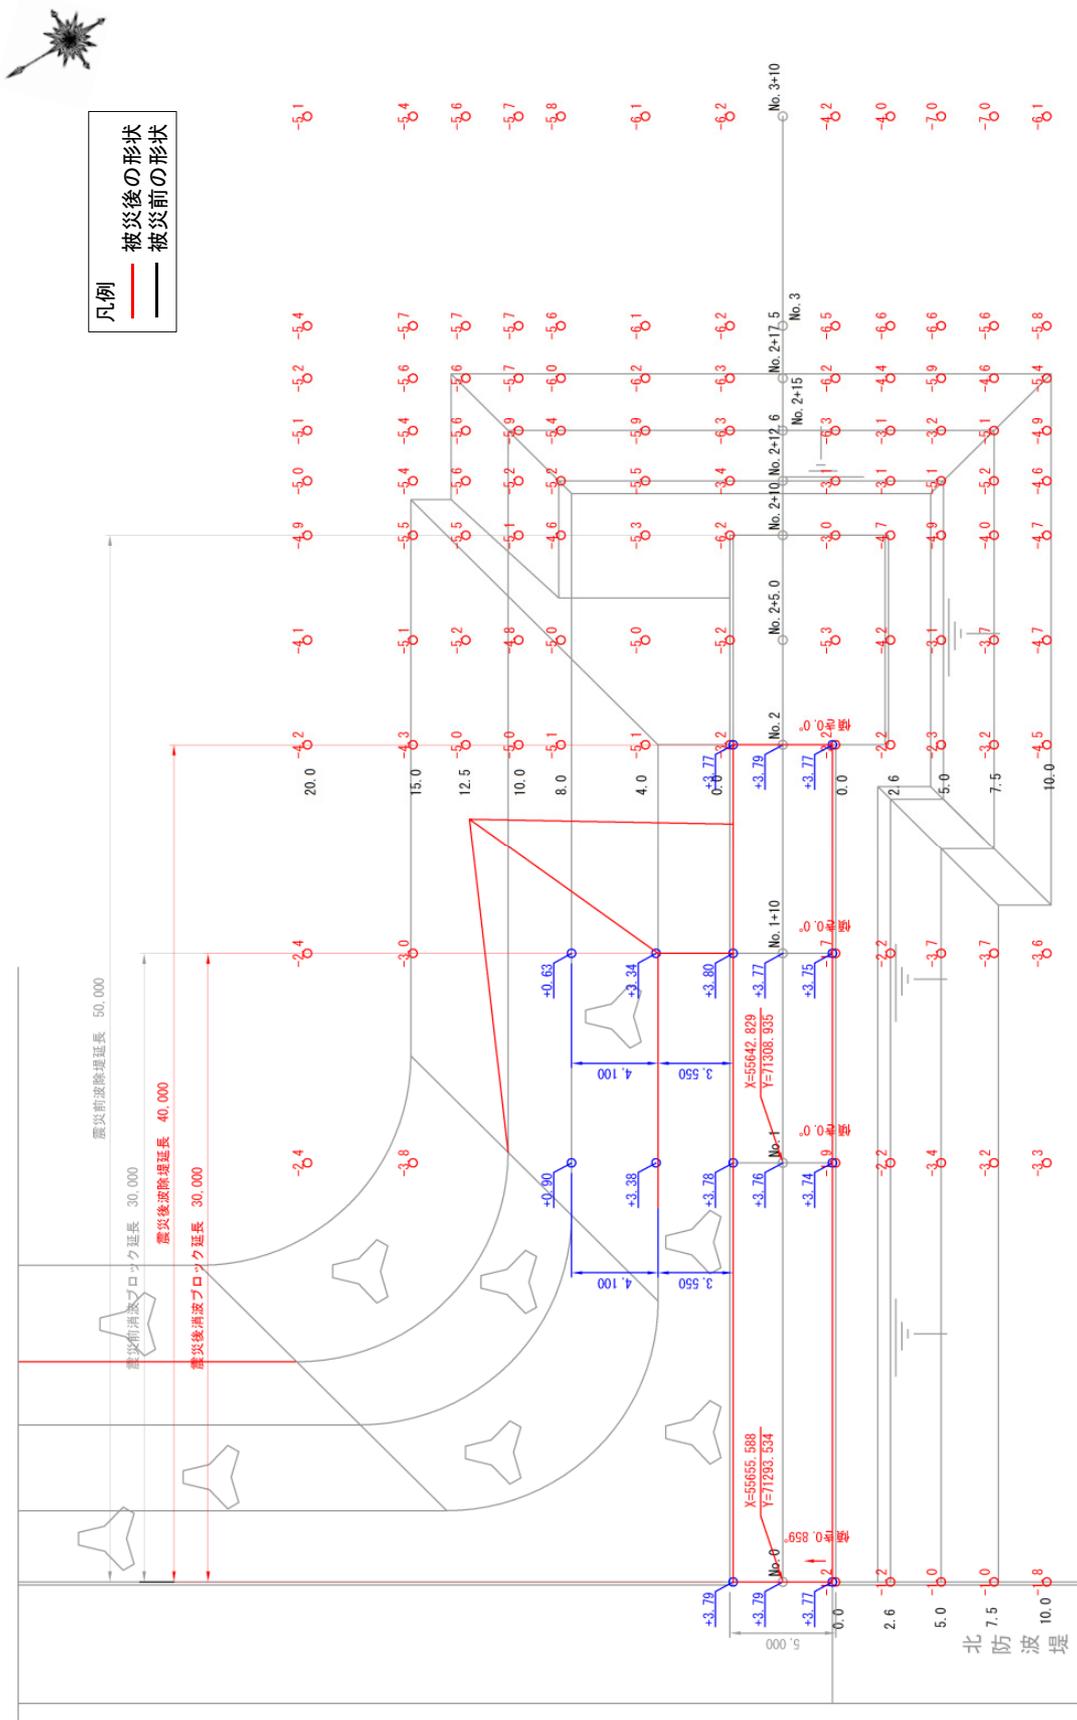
No.1 日立港区_本港地区東防波堤(波除堤)の平面図 (被災後)
